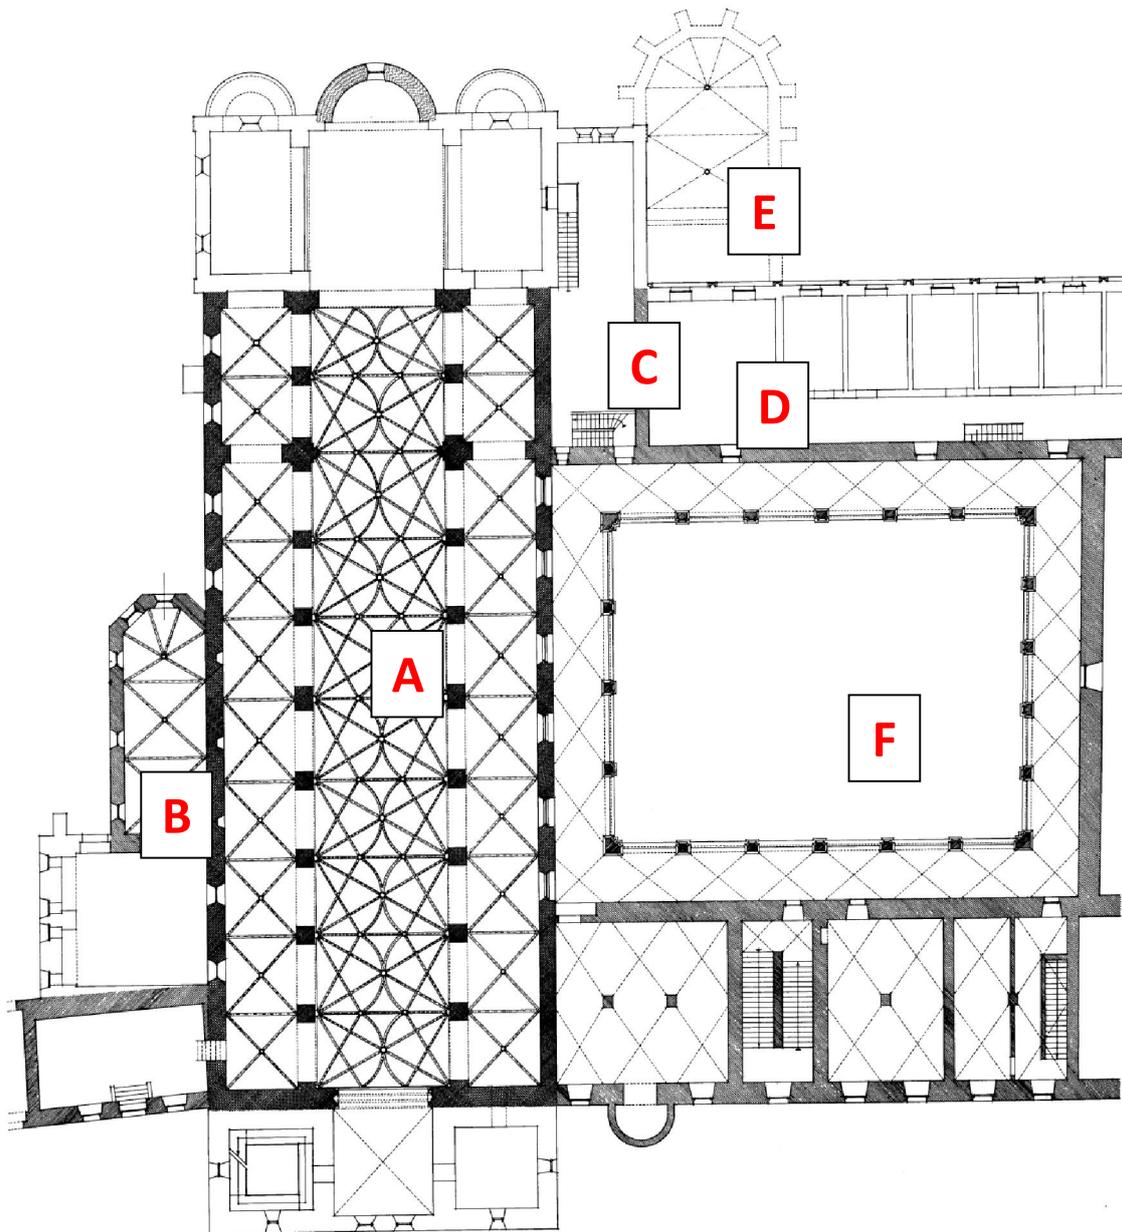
, Grundriss der Stiftskirche mit Gewölben (nach Roth)⁴¹³
